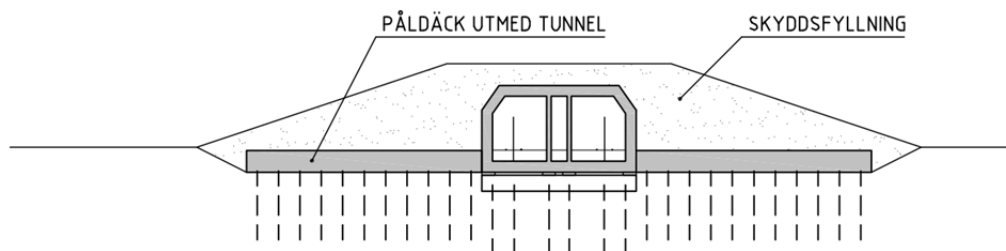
Ett pålgrundlagt betongdäck, påldäck, skyddar betongtunnelns grundläggningskonstruktion.
